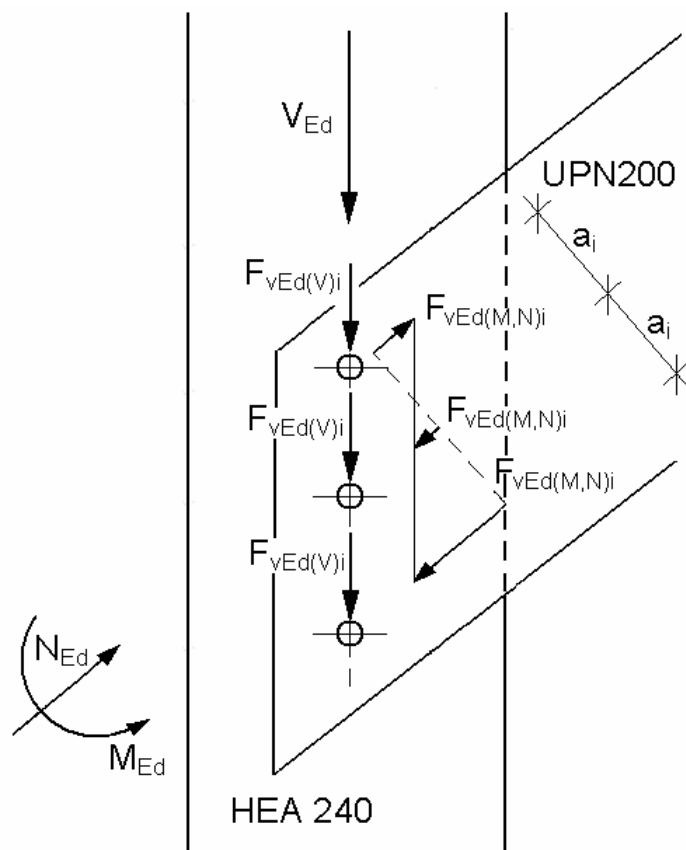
COLLEGAMENTO DIRETTO PILASTRO-IRRIDIMENTO
